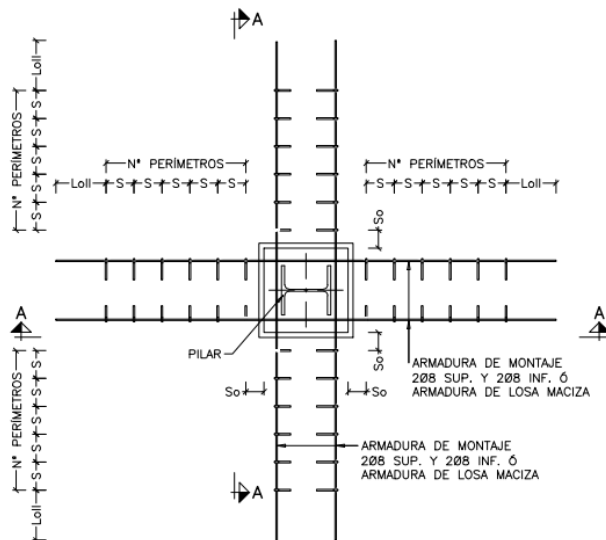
Detalle general armadura de punzonamiento con horquillas en pilares interiores.
